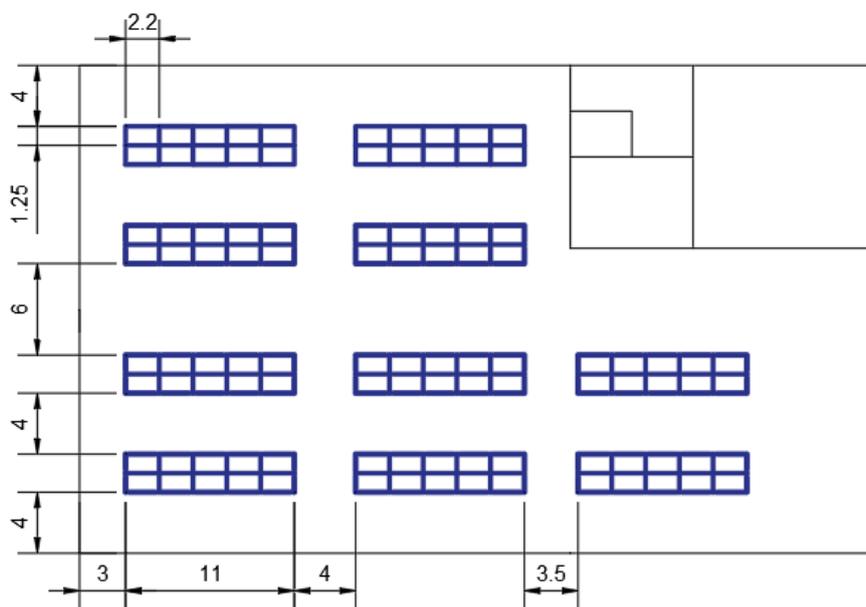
Vista en planta de la distribución de las estanterías en la nave industrial
